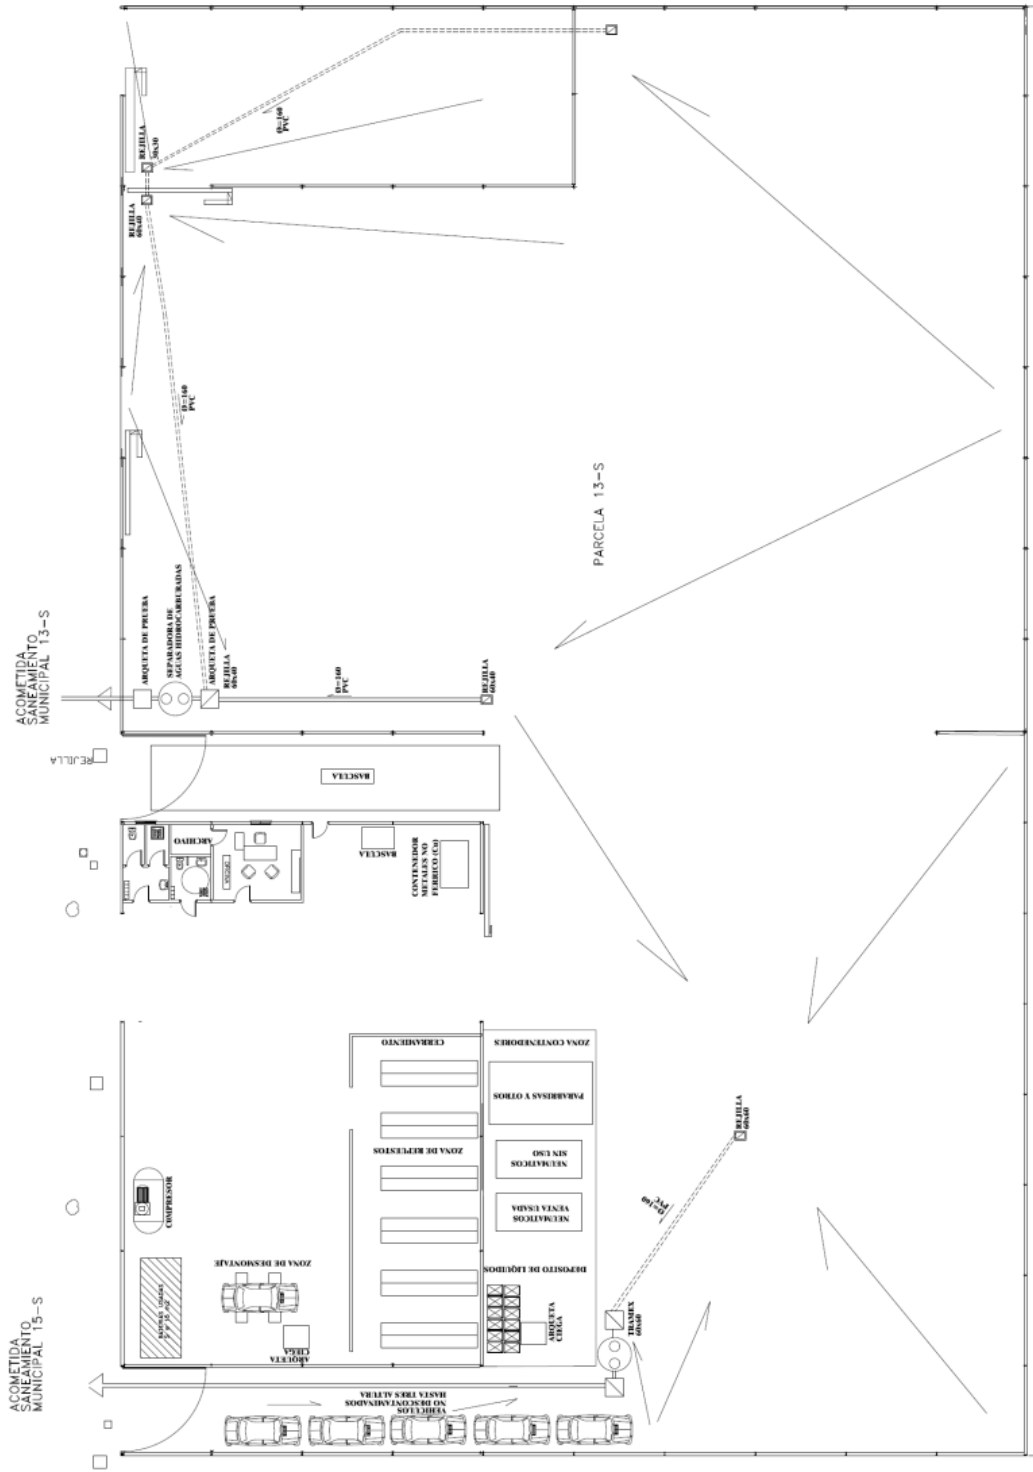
Plano en planta de la instalación industrial en el que se muestra la red de saneamiento
